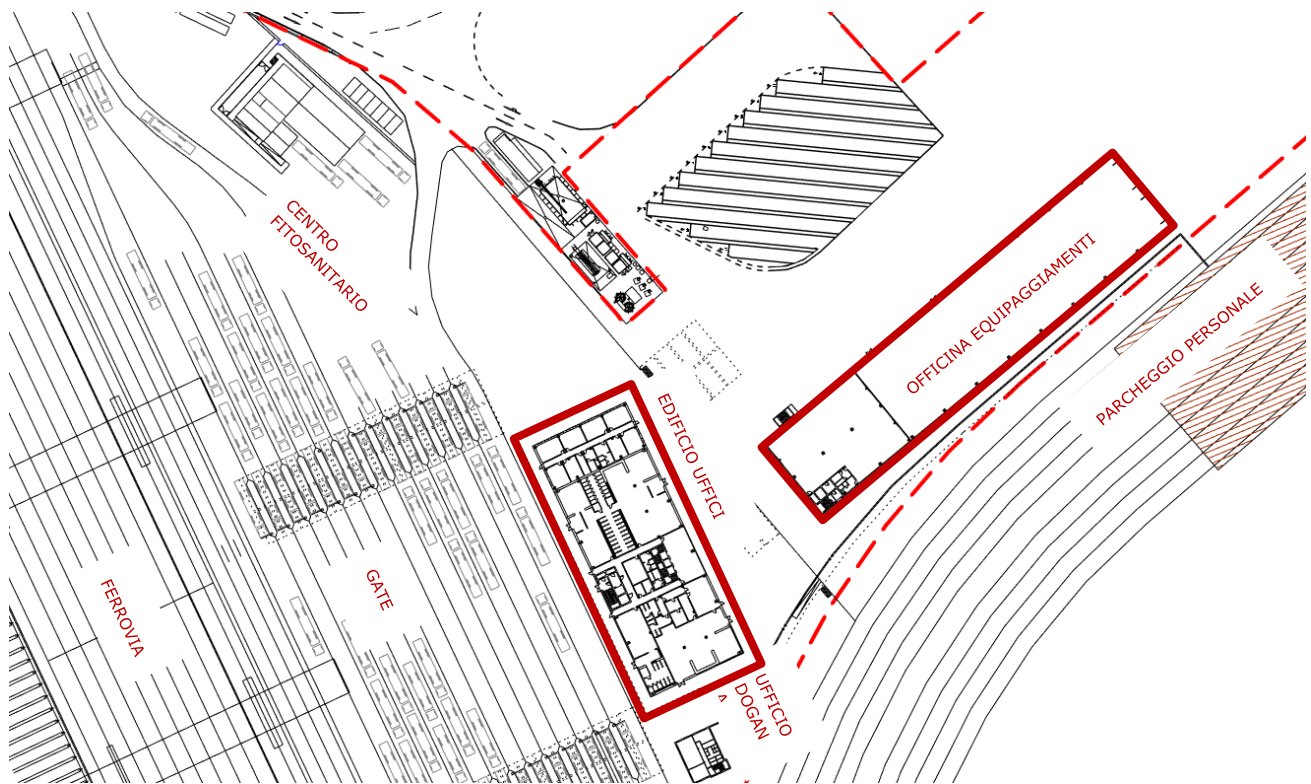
6ML8_P_G_E-ARC_4FA_001_07_00 – Planimetria edifici
